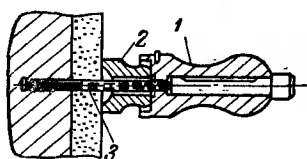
Закрепление ролика дюбелем бесшурупного крепления.
